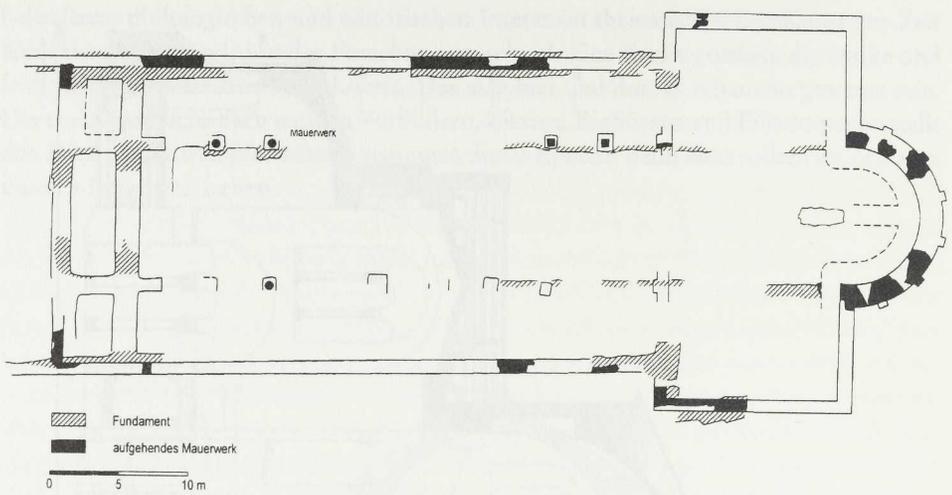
St-Denis, Abteikirche, Fulrad-Bau, Grundriß (nach Jacobsen)
